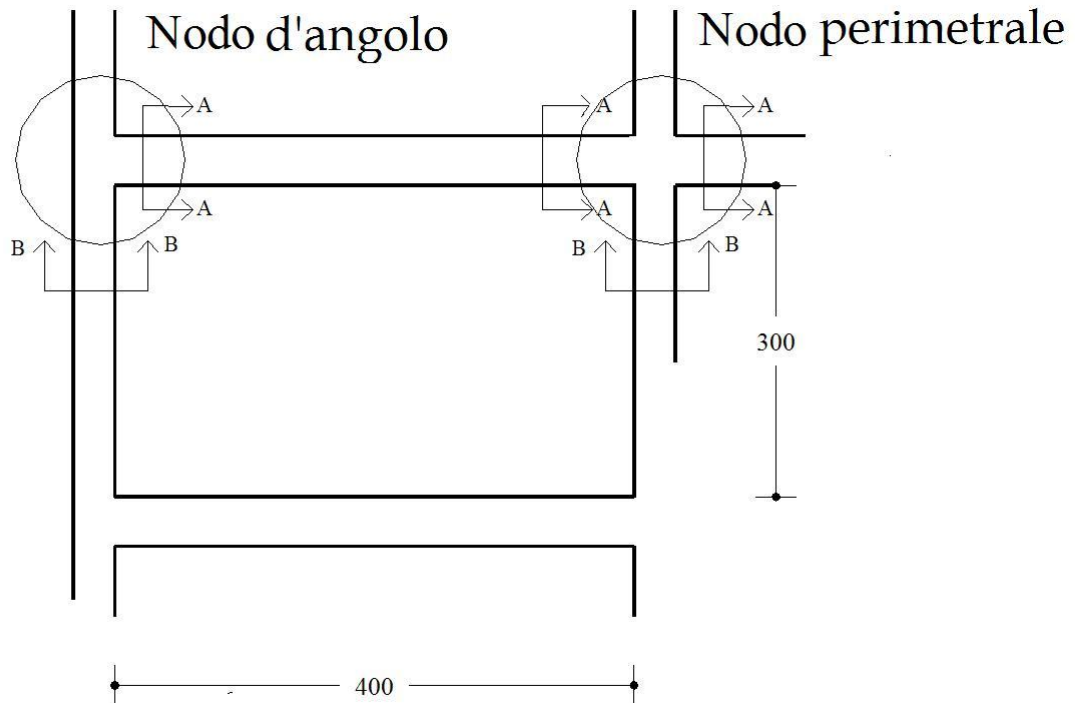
Vista di prospetto di una maglia di telaio (misure in cm)
